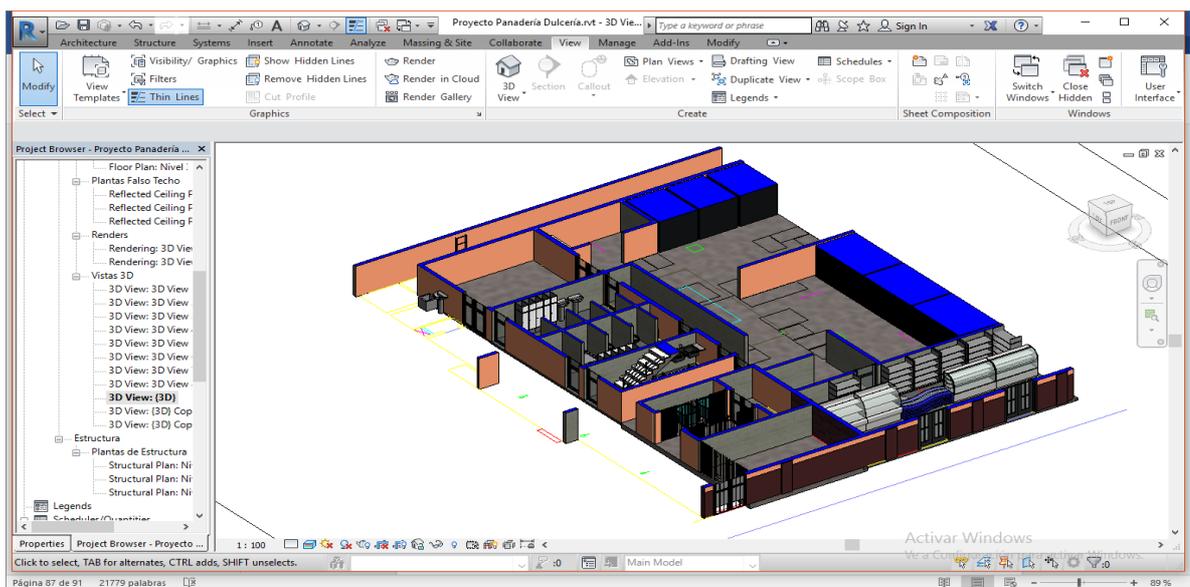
Vista en 3D de la primera planta. Fuente: Proyecto “Panadería Dulcería “Empresa IDEAR de Cienfuegos.
